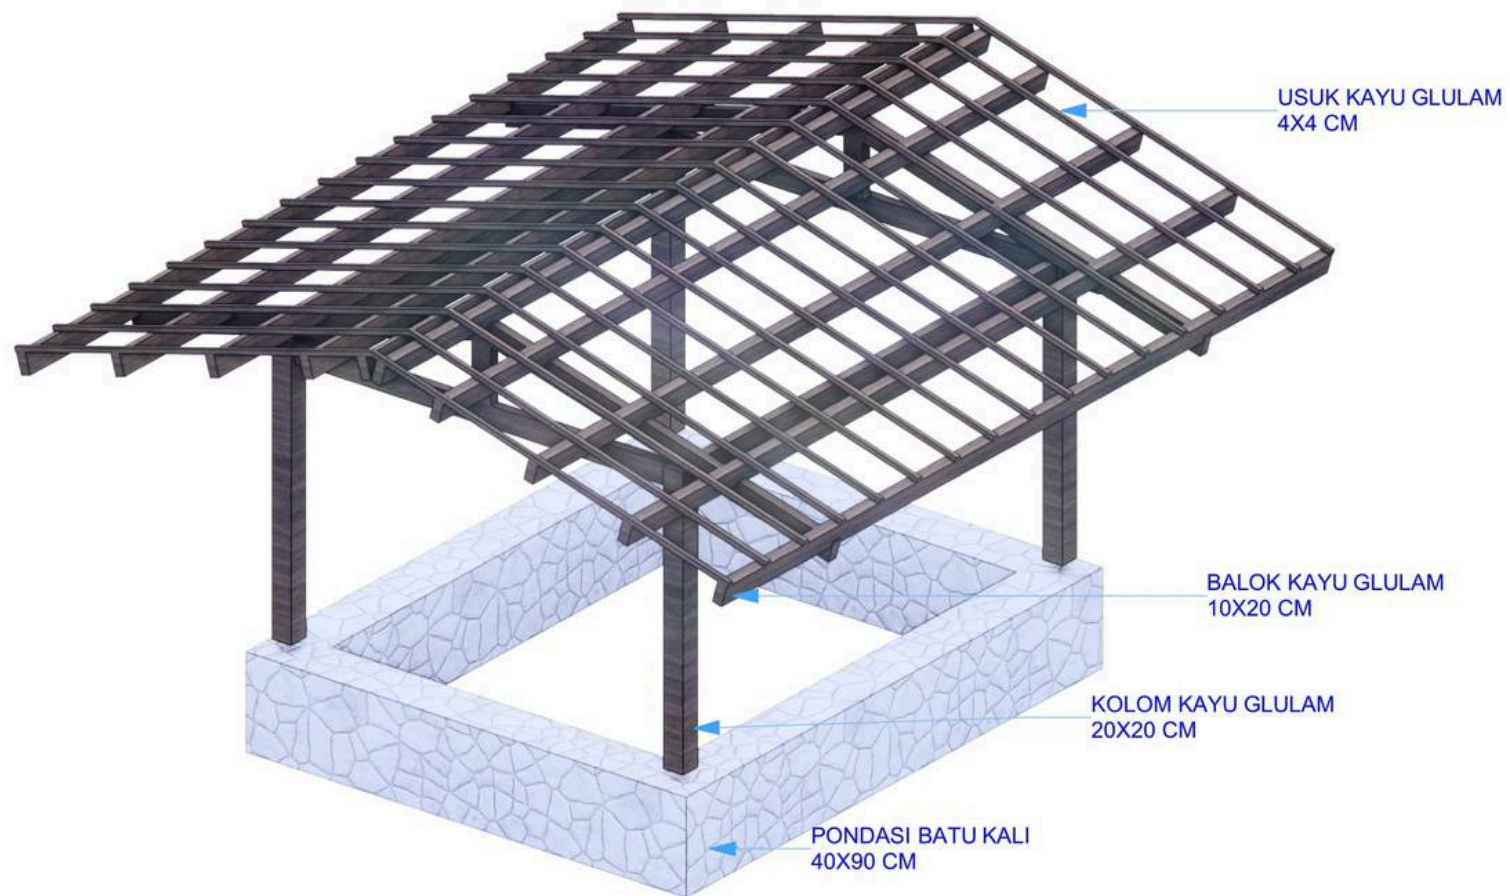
Struktur bentuk bangunan tipe C
